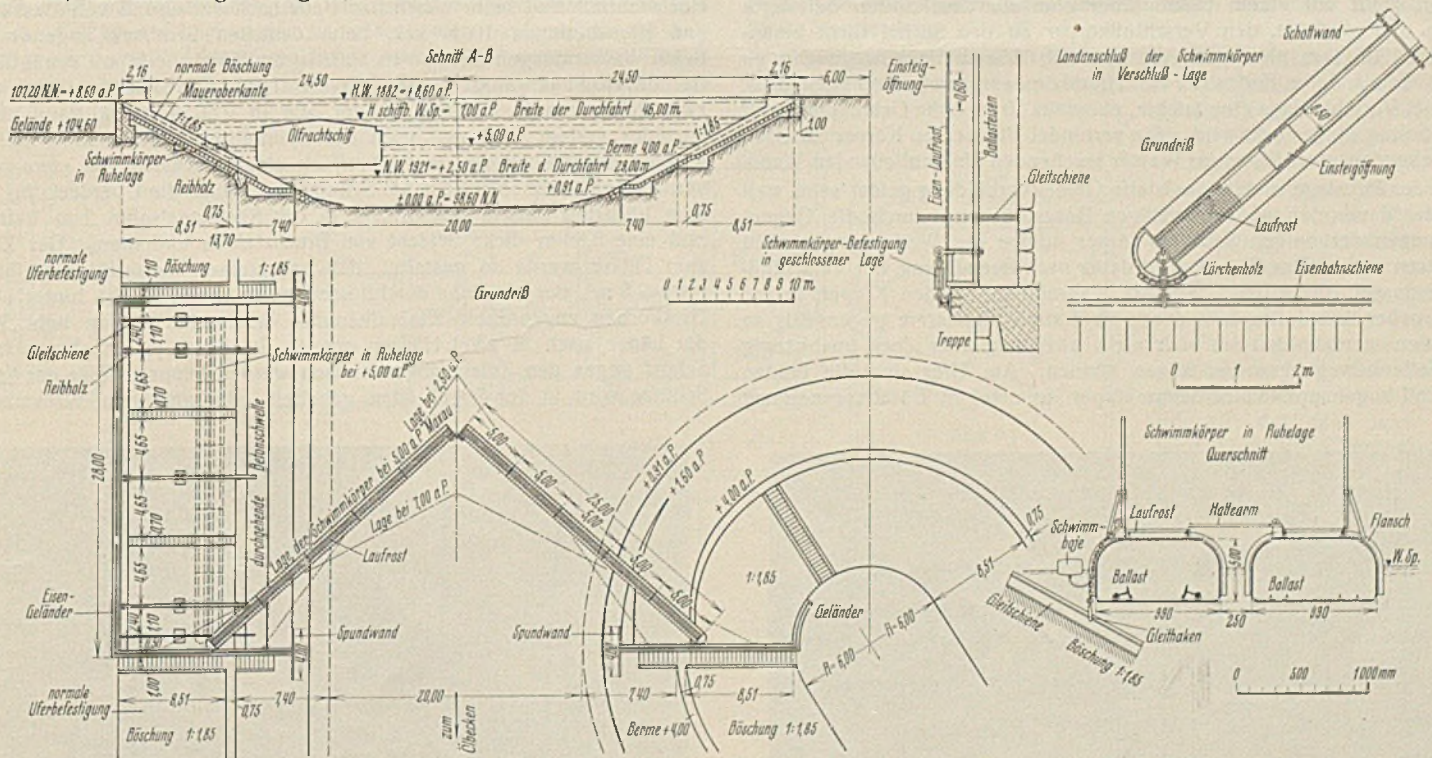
Verschlusseinrichtung für das Ölbecken.
